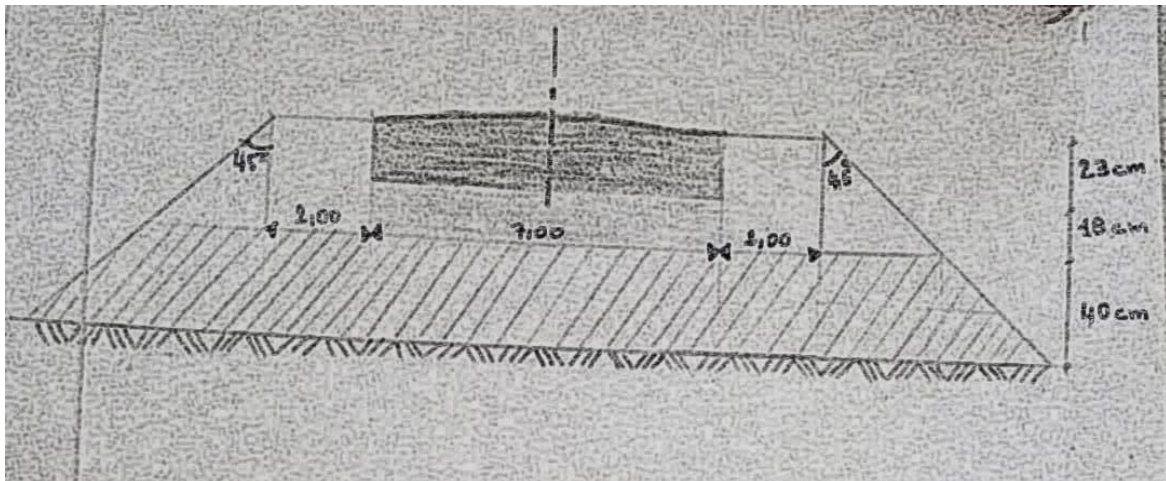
Schéma du profil en travers type de la chaussée rigide
